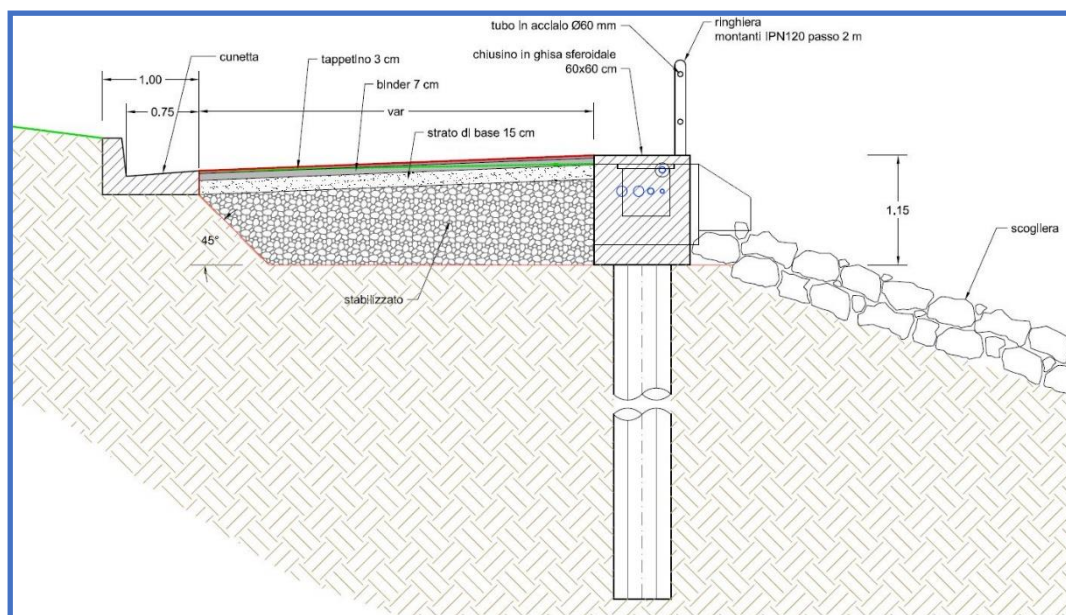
Zona intervento 1 – Sezione tipo dell'intervento
